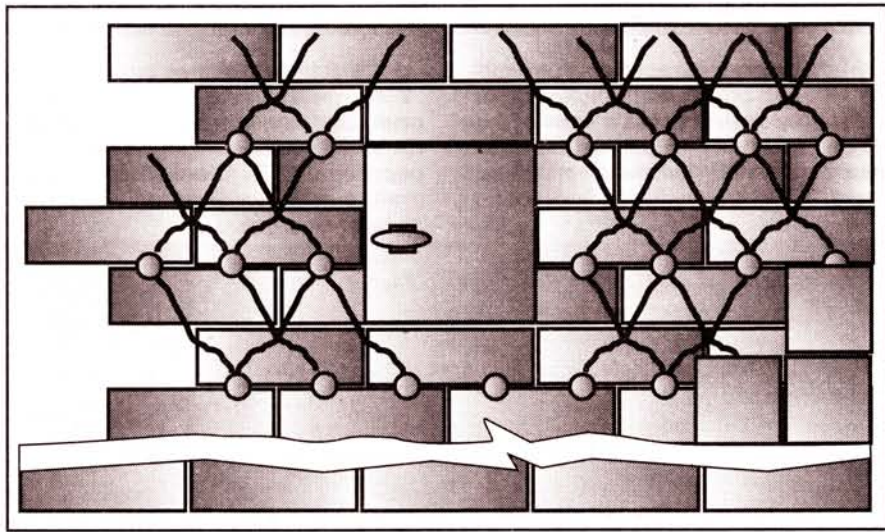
Подготовка поверхности печи к обмазке или облицовке плиткой.
